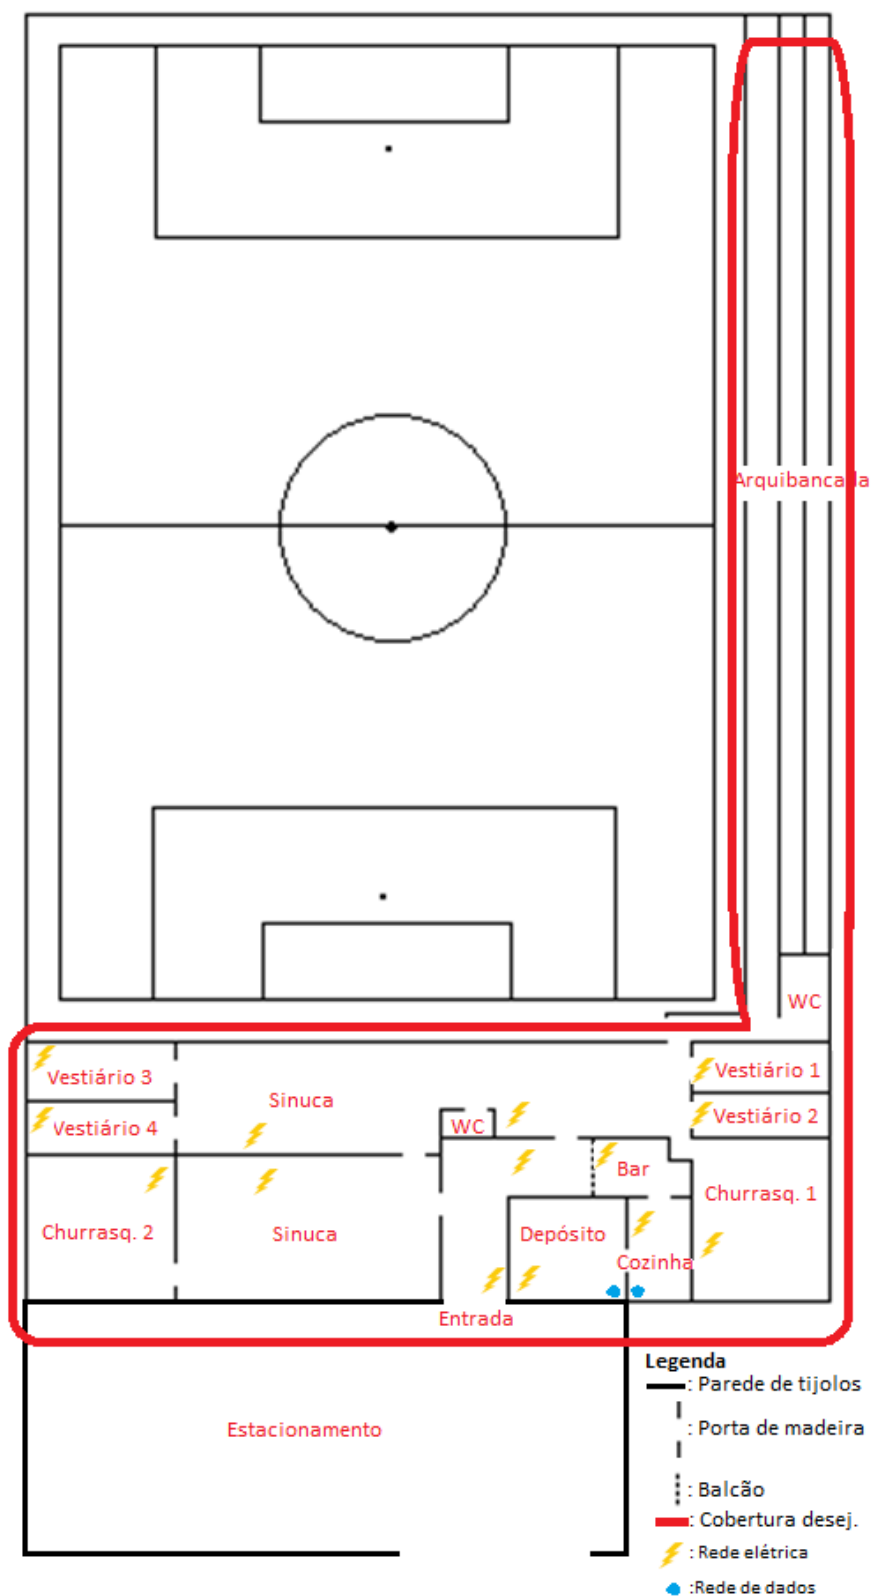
Planta baixa com cobertura desejada e infraestrutura existente
